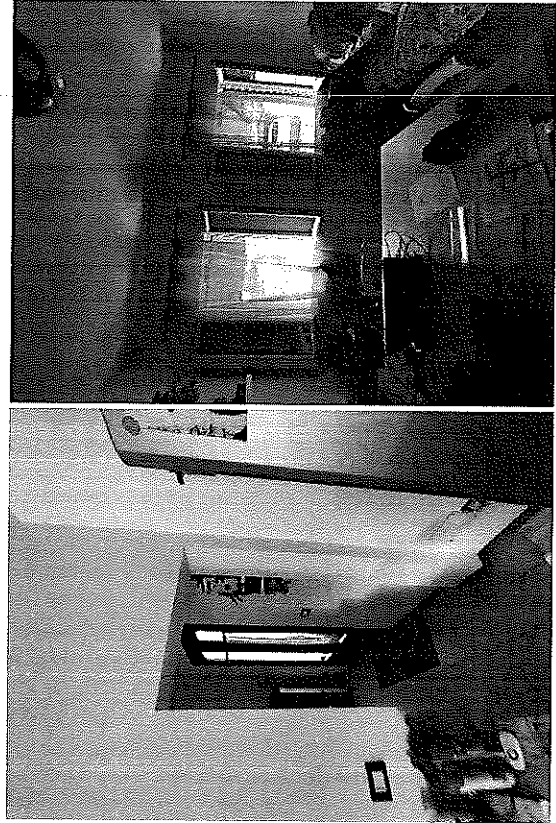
Vista della cucina al piano terra sul fondo il corridoio di ingresso.
